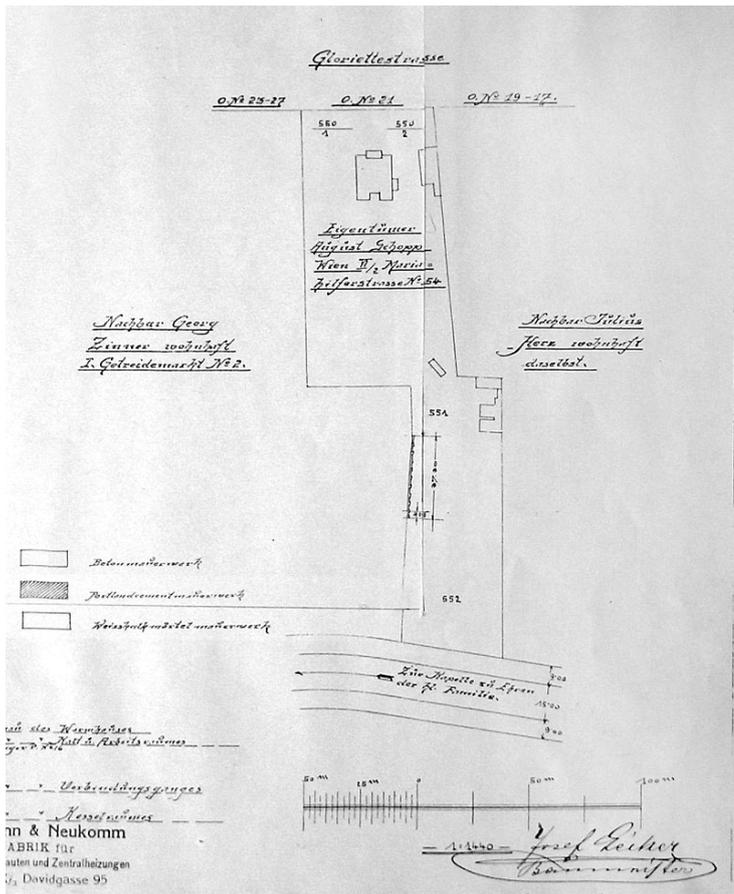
Haus Schopp. Situationsplan. 1910. Einreichplan.
